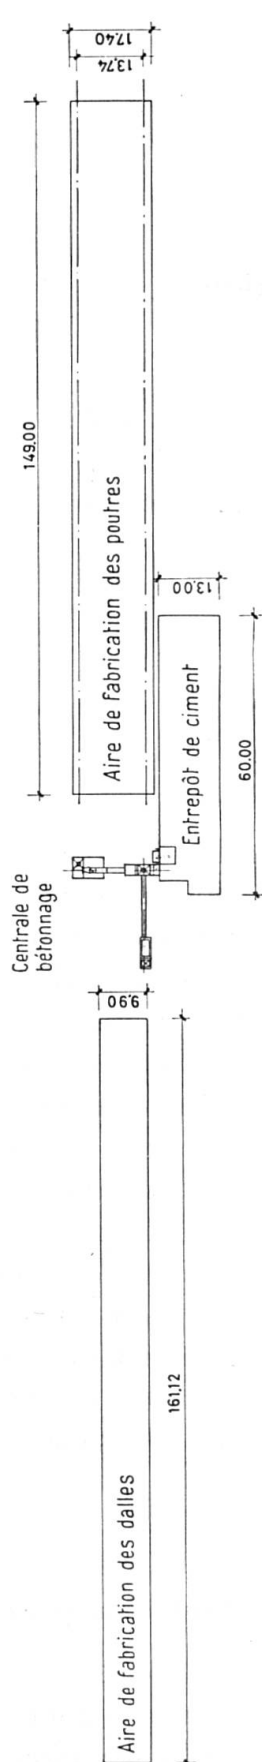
Chantier de préfabrication du hall de laminage de *Ensidesa* (Avilés).
